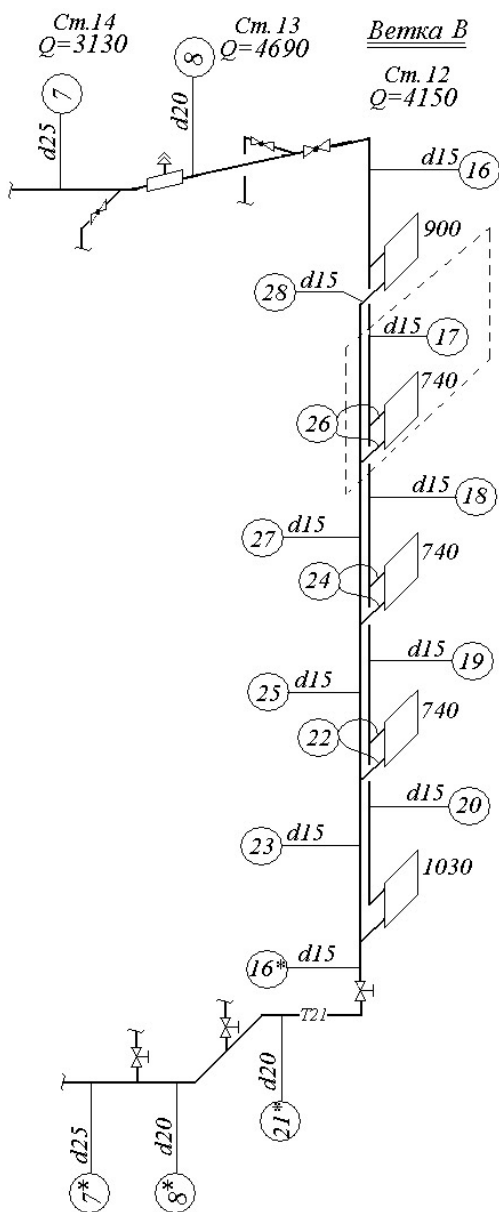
Фрагмент двухтрубной вертикальной системы отопления (см. рис. 6.1) с выделенным расчетным отопительным прибором 4-го этажа Ст.12.
